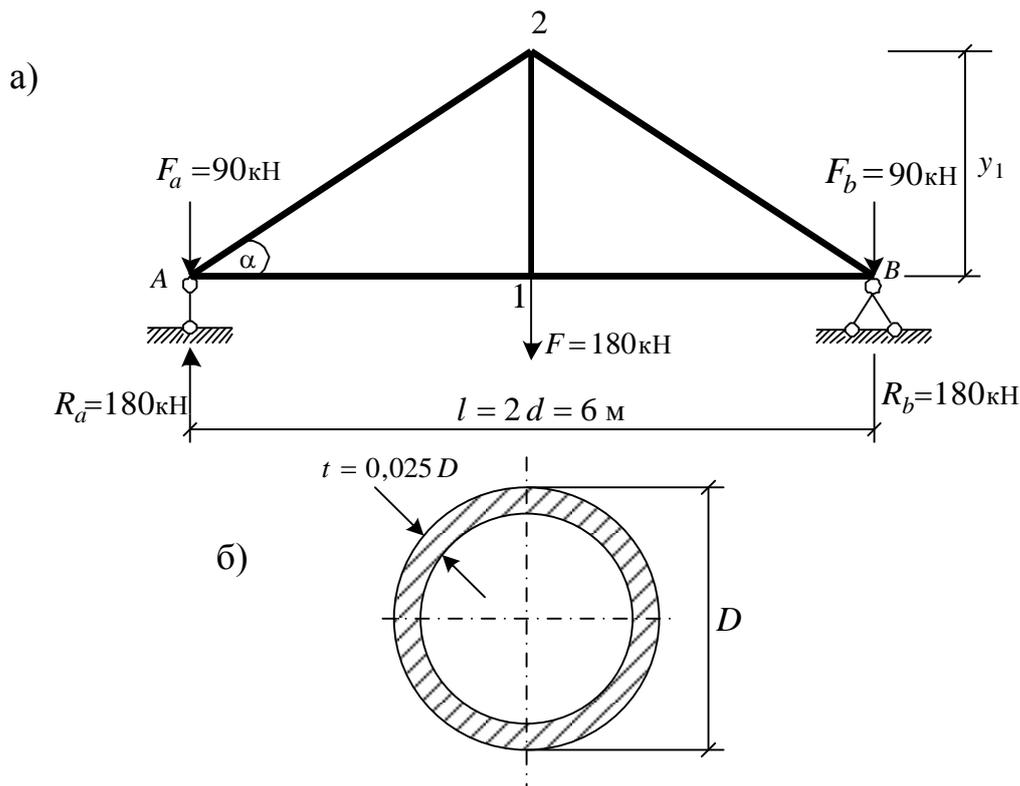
Ферма: а – расчетная схема, б – трубчатое сечение стержня фермы
